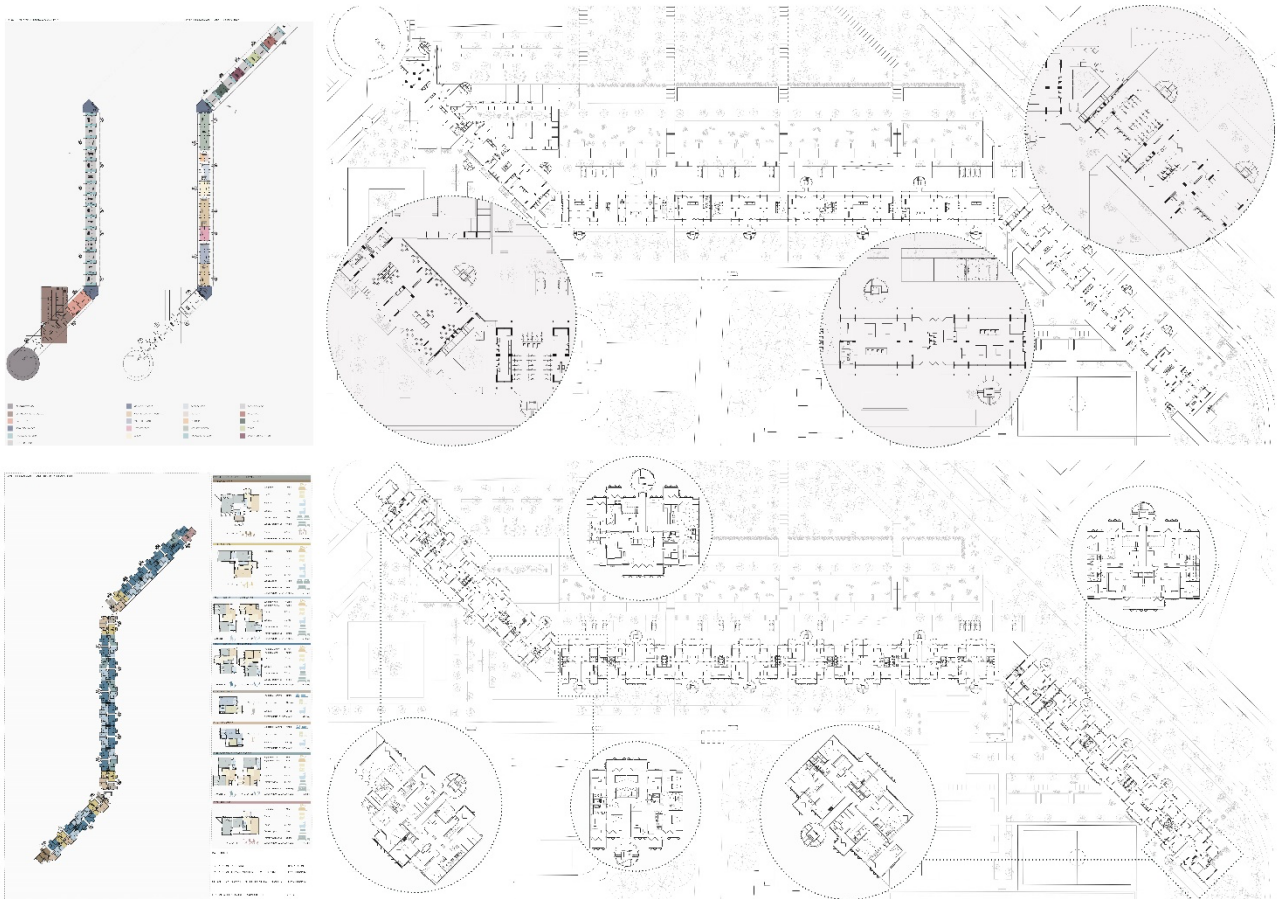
Layout funzionale, pianta del piano terra e piano tipo con zoom sui nodi principali
